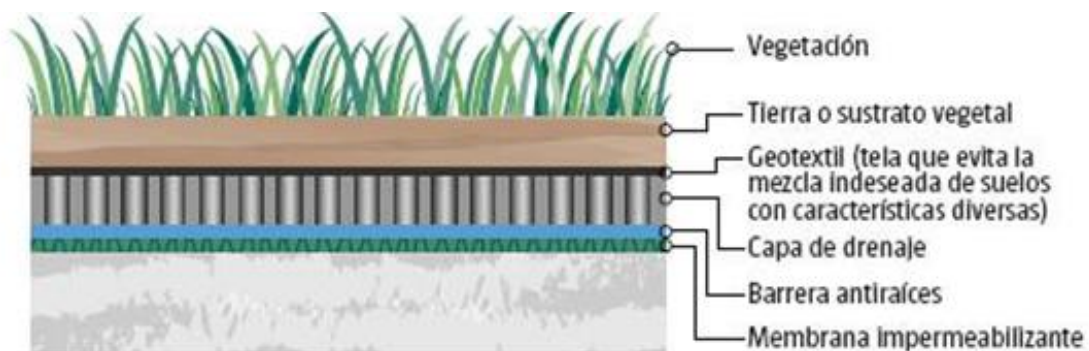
Cubierta vegetal, extraído de: <http://www.tumejorhipoteca.es/2011/09/ventajas-de-vivir-bajo-un-jardin.html>
